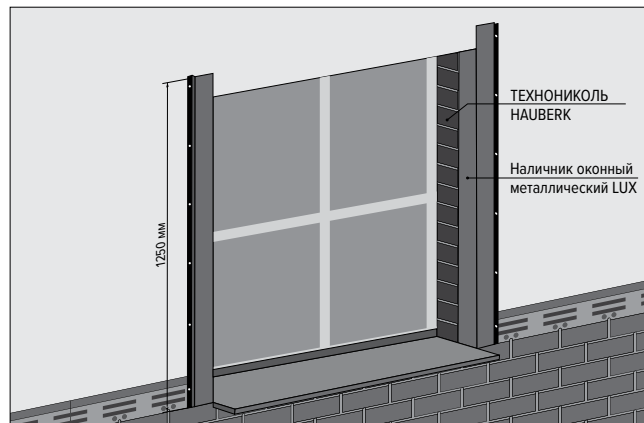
Монтаж фасадной плитки вокруг оконных проемов
